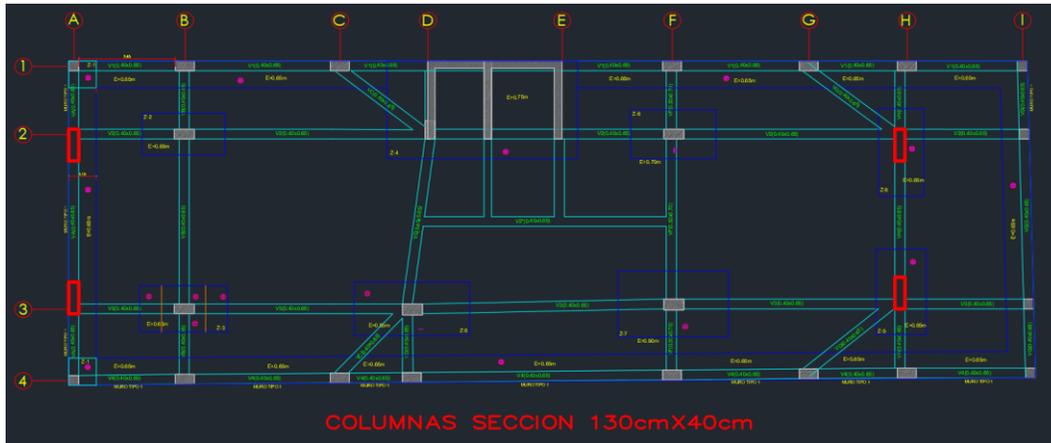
columnas 130cmX40cm (fuente: elaboración propia Edificio Fourvière)
